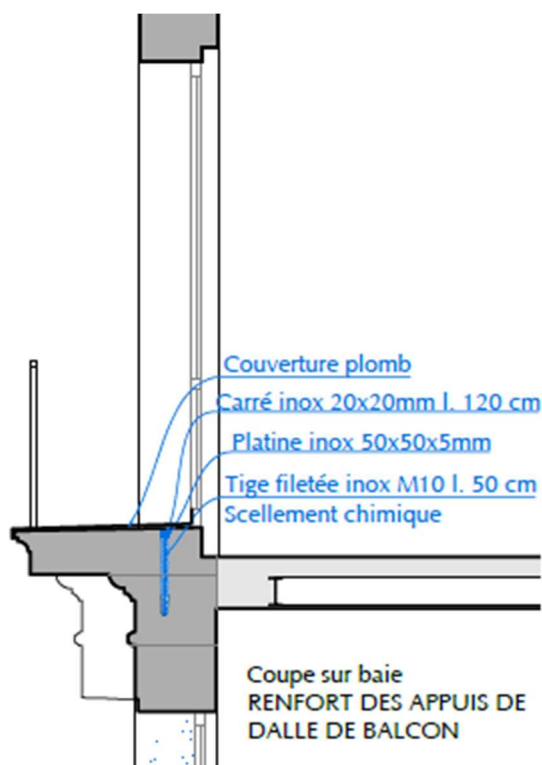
Plan d'un balcon, mise en évidence du renforcement des appuis de dalle.
